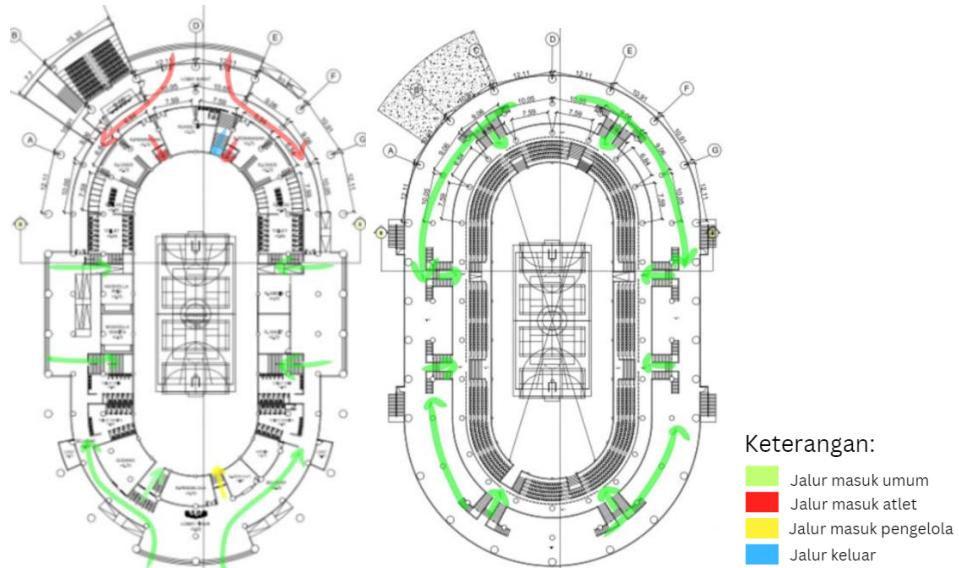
Zonasi ruang lantai 1 (kiri) dan zonasi ruang lantai 2 (kanan)
